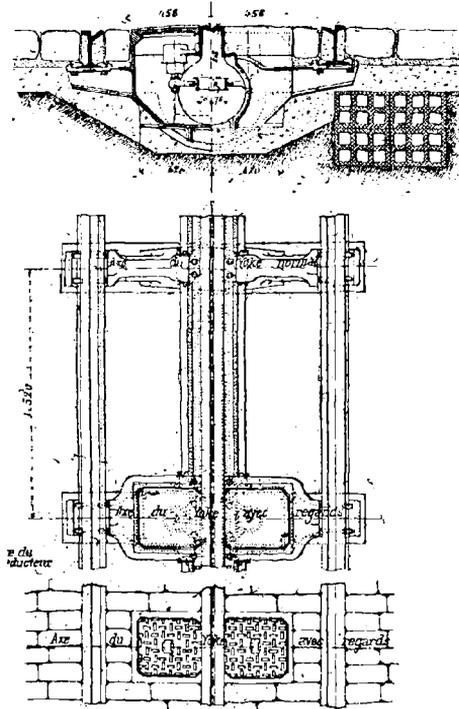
Caniveau de la Metropolitan Street Railway Co.
